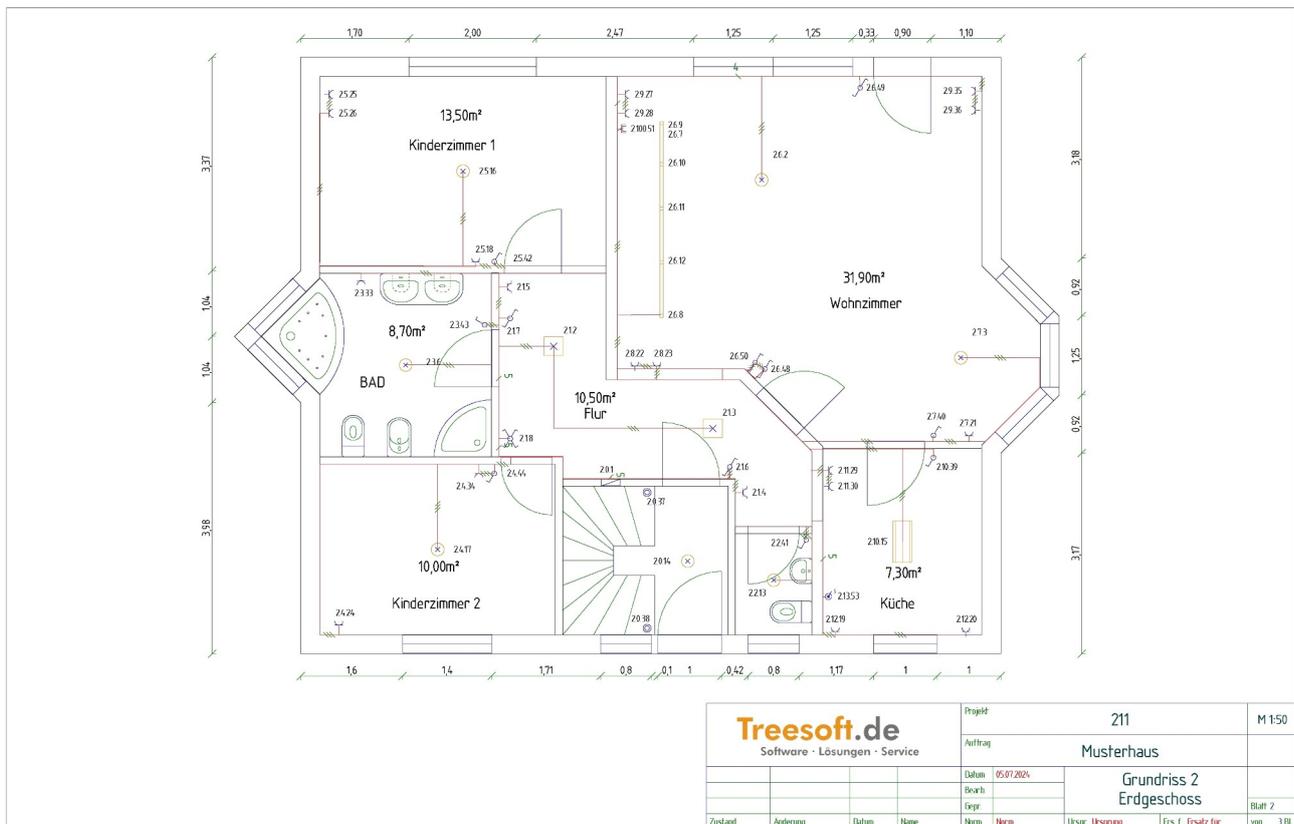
Fertig projektierter Elektroinstallationsplan (Grundriss eines Einfamilienhauses)
